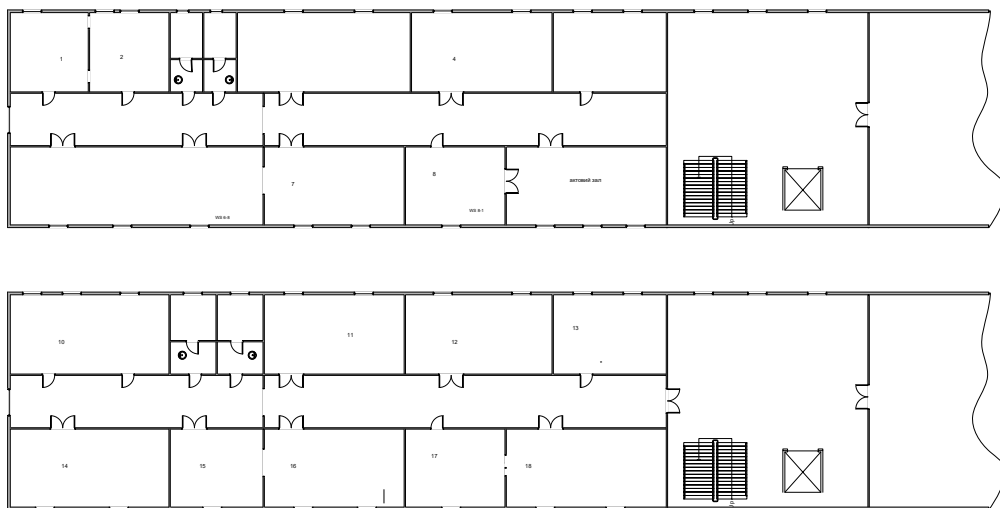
План першого і другого поверху адміністративної будівлі
